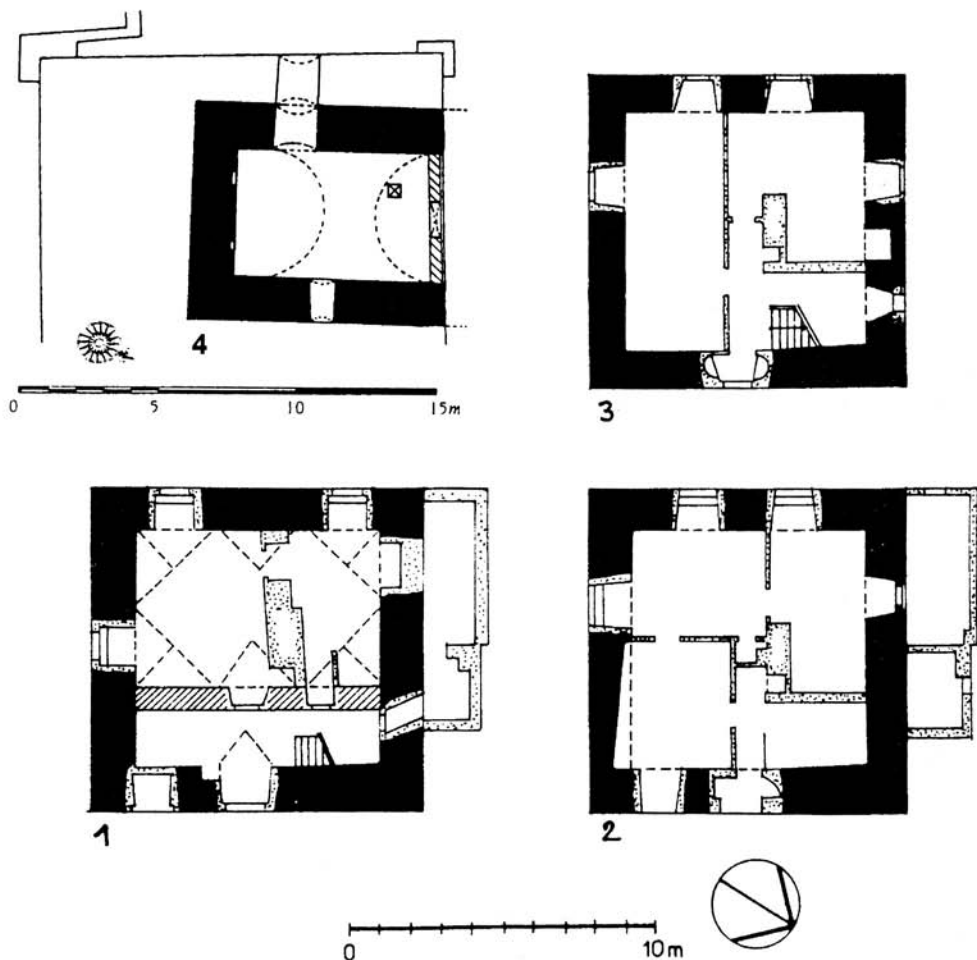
Královice. Grundrisse des Erdgeschosses (1), 1. (2) und 2. (3) Stockwerkes der Feste. Dubeč. Grundriss des Souterrains der älteren Feste nach J. Úlovec (4). Schwarz – Mauerwerk des 14. Jahrhunderts. Zeichnung: P. Chotěbor.
